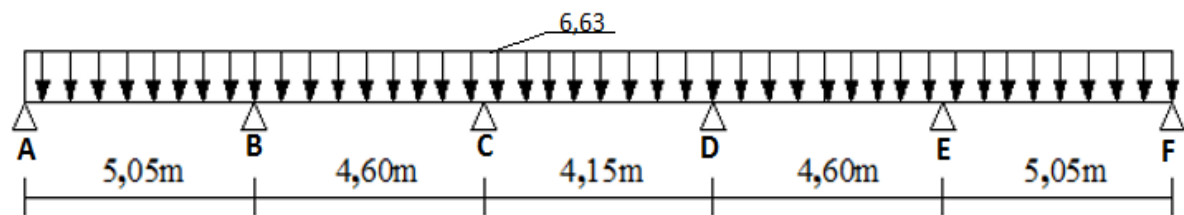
Schéma statique de la poutre continue reposant sur 6 appuis
